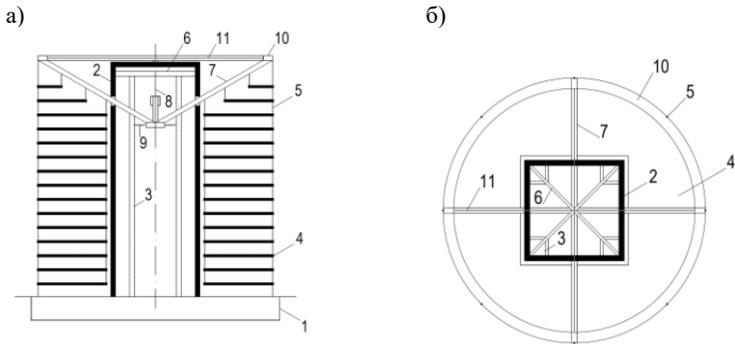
Предлагаемое конструктивное решение здания с подвешенным оголовком: а) вертикальный разрез здания; б) план здания; 1 – фундамент; 2 – несущий ствол; 3 – лифтовые шахты; 4 – плиты перекрытий; 5 – подвески; 6 – балки; 7 – радиальные балки; 8 – тяж; 9 – амортизаторы; 10 – опорное кольцо; 11 – растяжки
